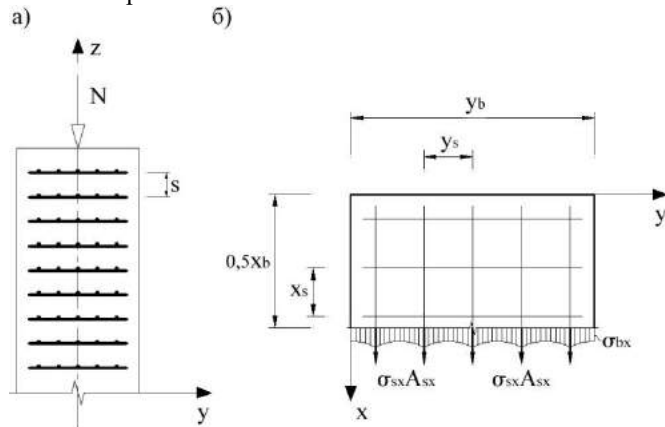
Железобетонный элемент с сетчатым армированием: а – вид сбоку; б – схема усилий в рассматриваемом фрагменте
